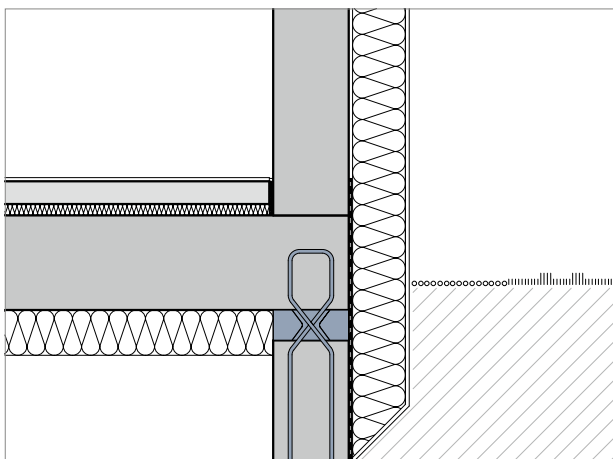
Schöck Sconnex® Typ W bei Aussenwand und Unterdeckendämmung
